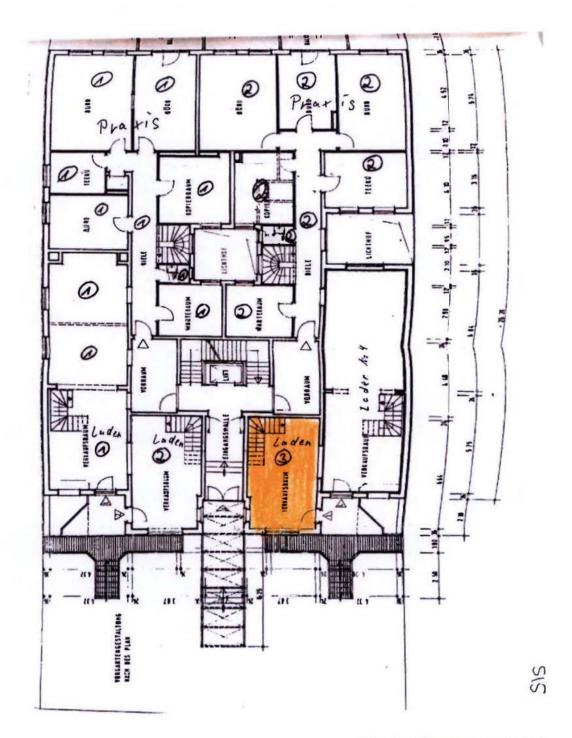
Ausschnitt Grundriss Untergeschoss
